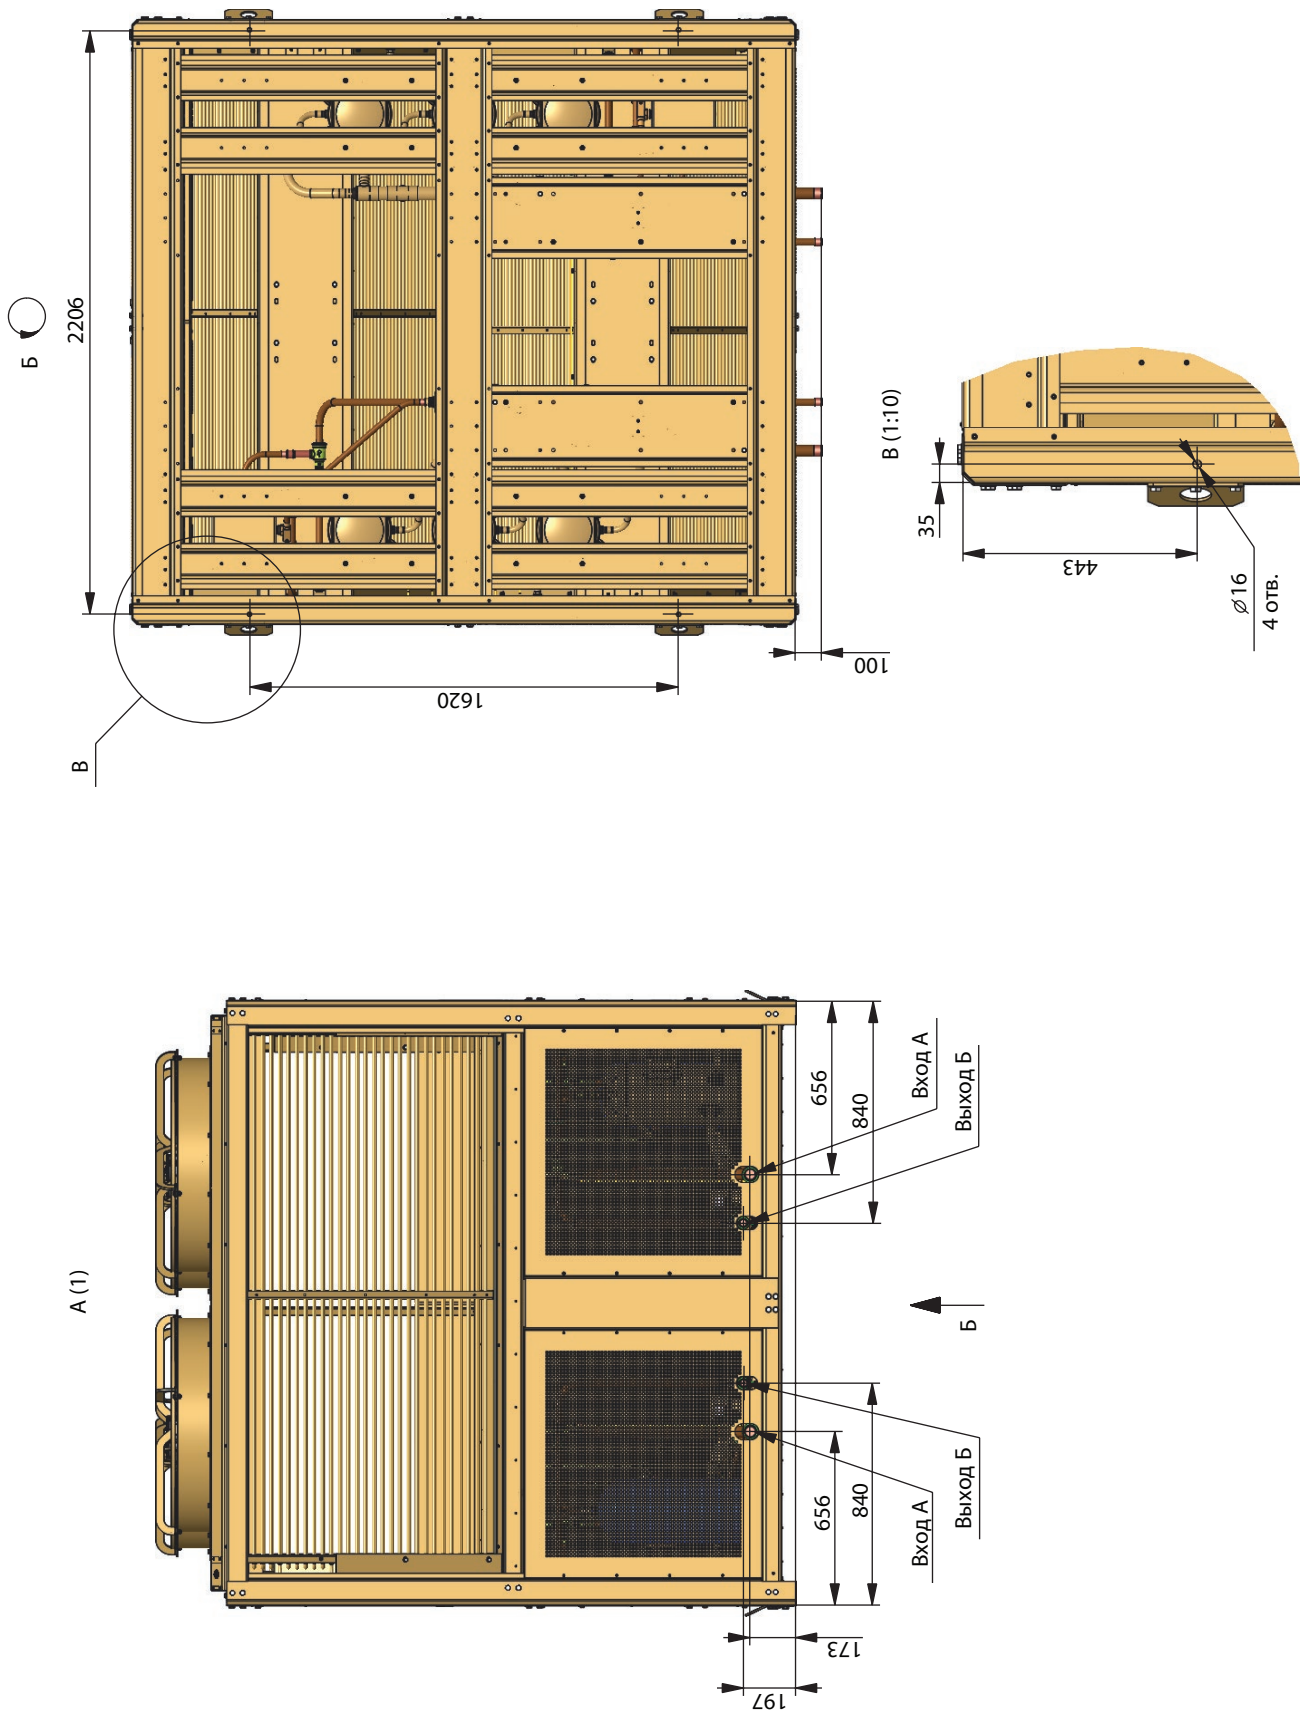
Агрегат компрессорный типа МАКК 330-1902, -2102, -2402, -2802, -3002
